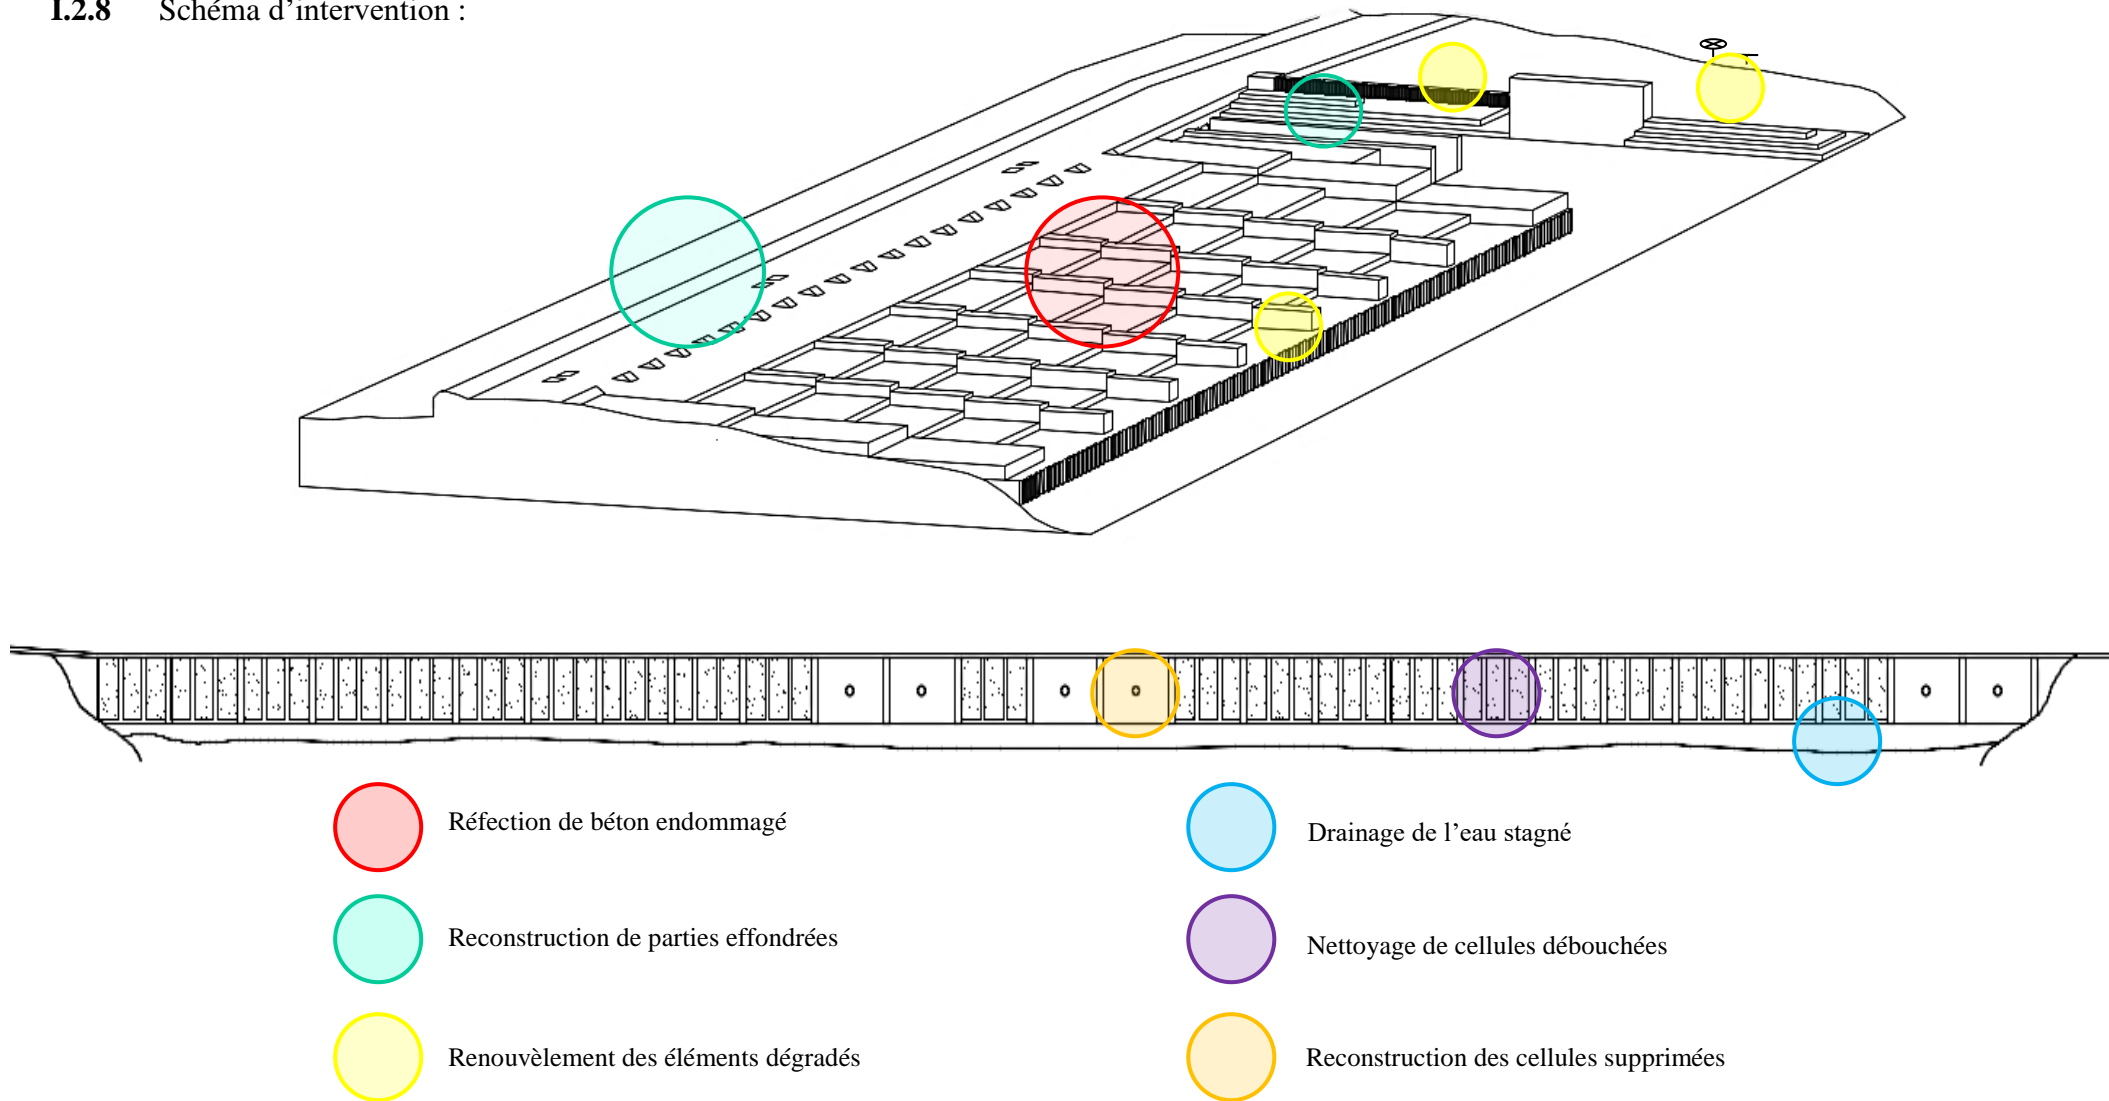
Schémas d'intervention du barrage de Tadjmout
